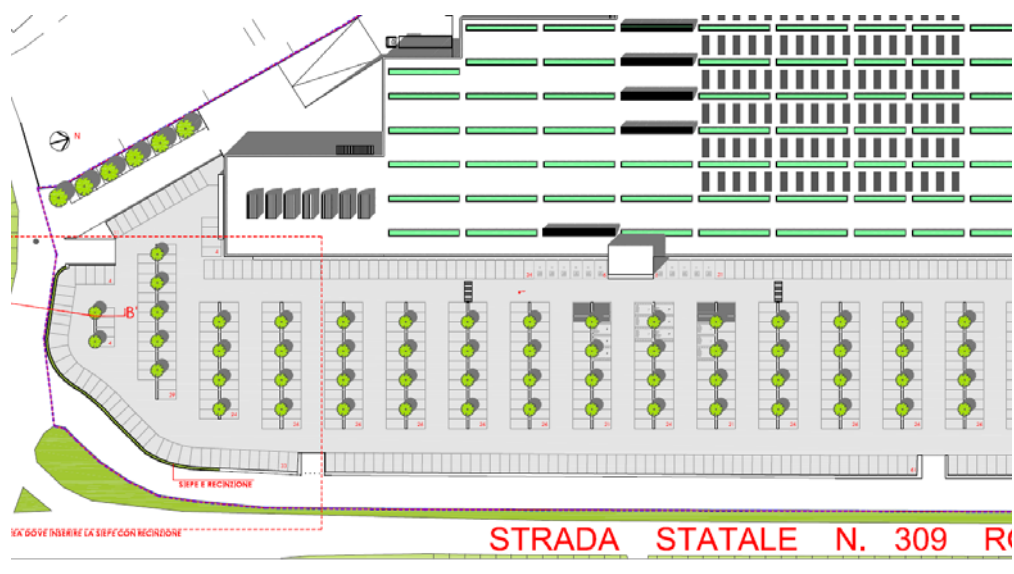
Planimetria della sistemazione a verde del parcheggio.
